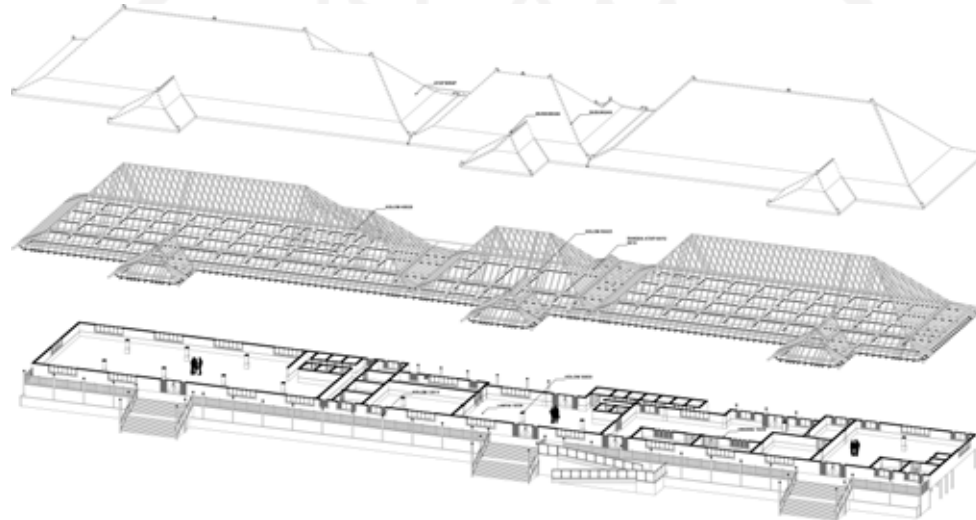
Denah Bangunan Unit tipe Deluxe
